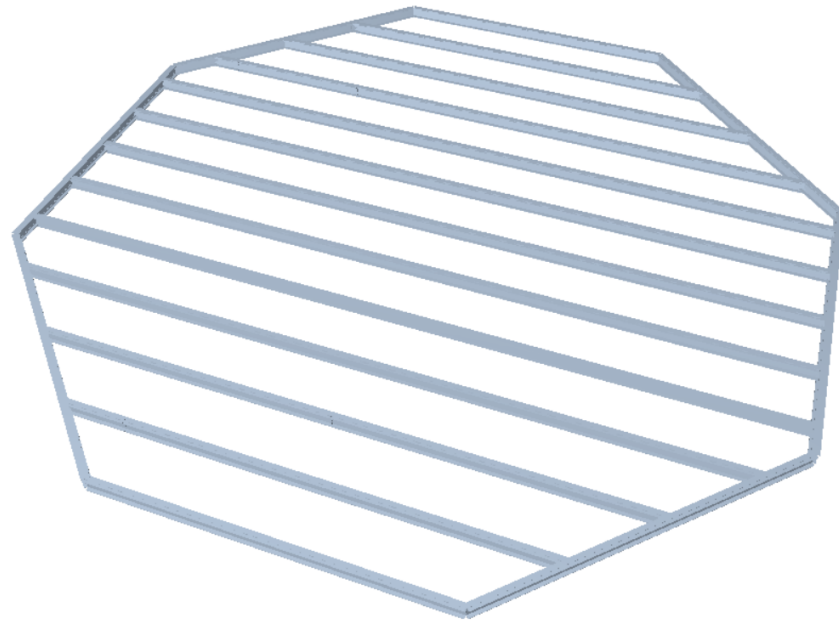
Estructura soporte para panel de aluminio. Fuente: Propia.
